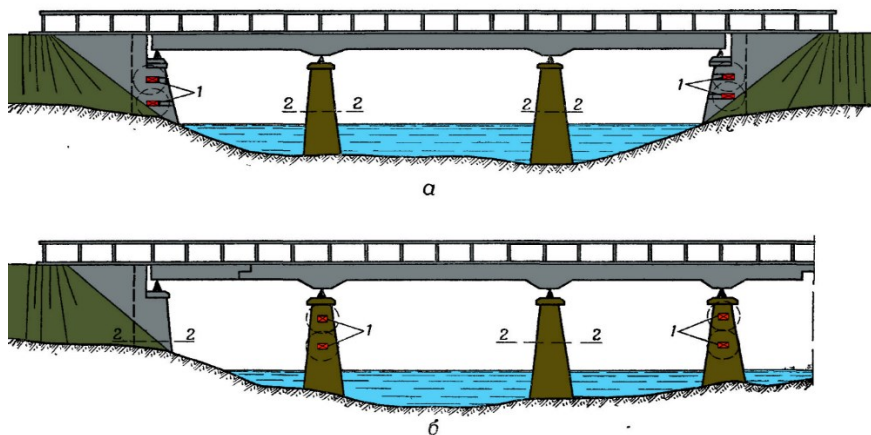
Взрывание балочных железобетонных мостов неразрезной и консольной конструкции: *а* – мост неразрезной конструкции; *б* – мост балочно-консольной конструкции; *1* – заряды для взрывания опор по косым сечениям; *2-2* – сечения взрыва опор по всей ширине в одном уровне
